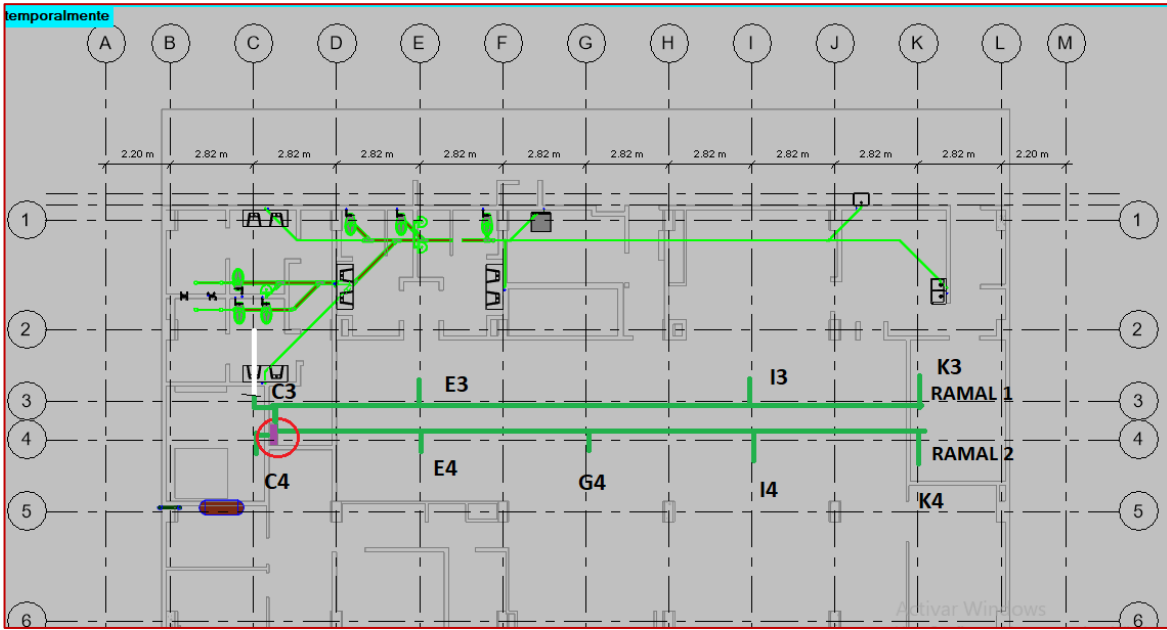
nodos de ramales en techo de planta baja que recolectan los flujos de columnas.
